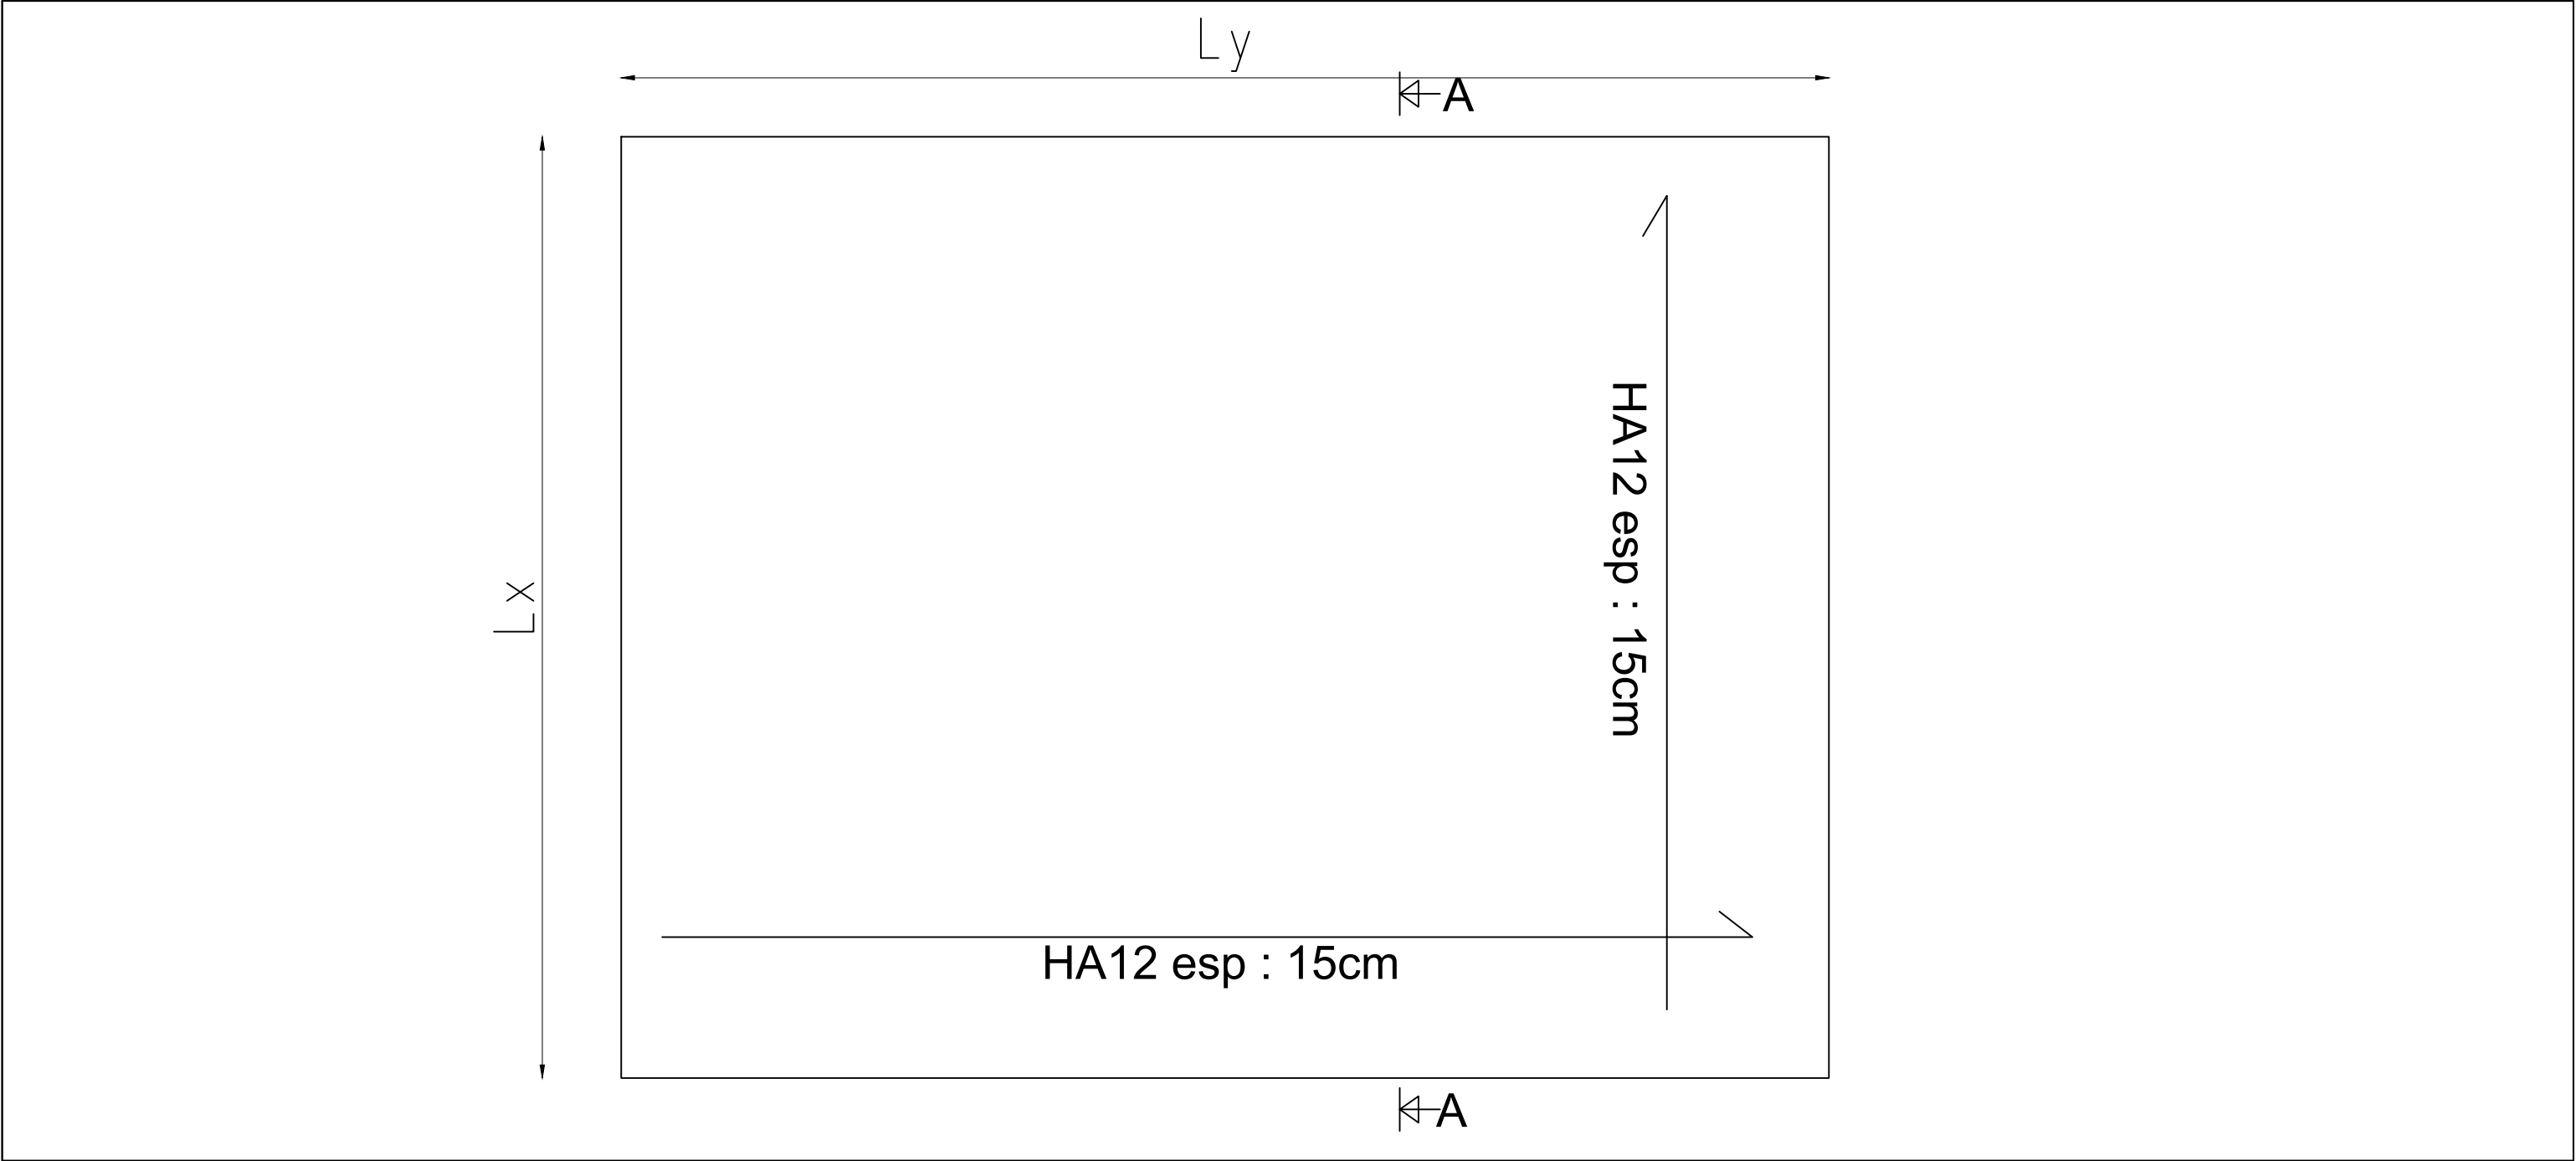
DETAILS FONDATION AU NIVEAU DE LA SEMELLE
